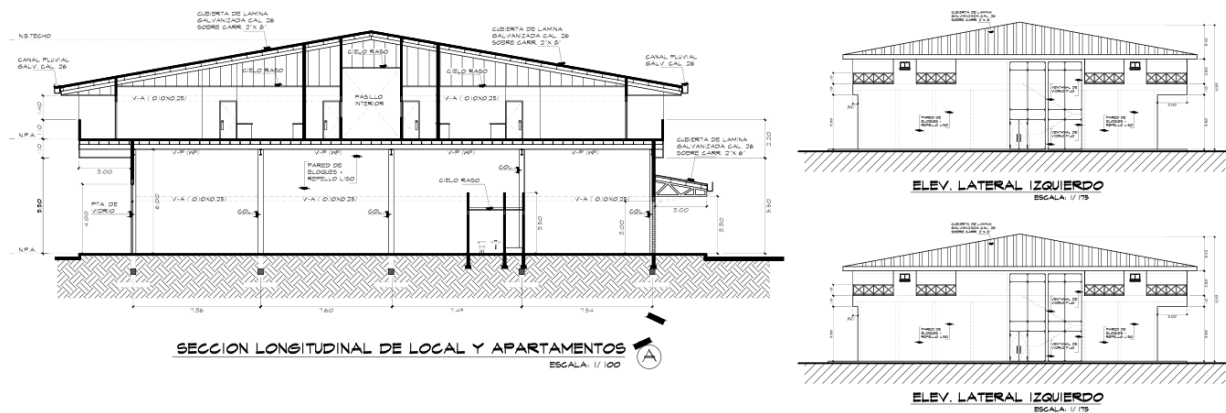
Sección longitudinal de locales y apartamentos y elevación lateral derecha e izquierda
